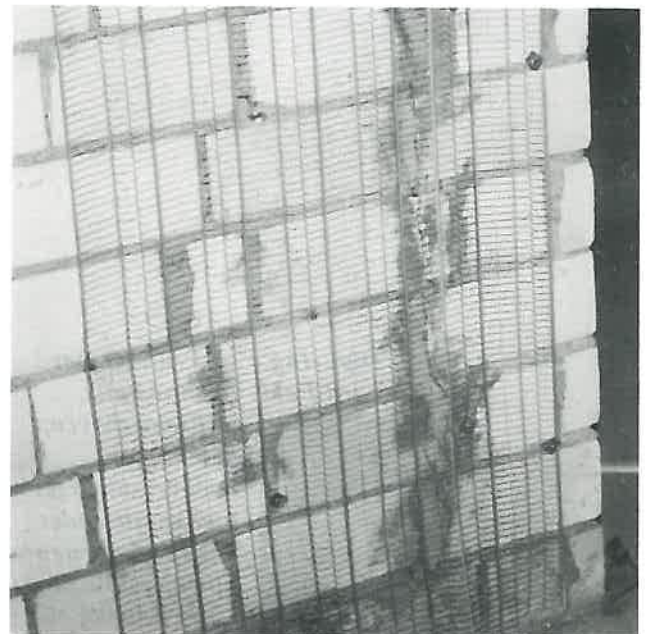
Risse im Innenmauerwerk über Balken (Pos. 40, Abb. 2), mit Ziegeldraht vor dem Putzen überspannt
